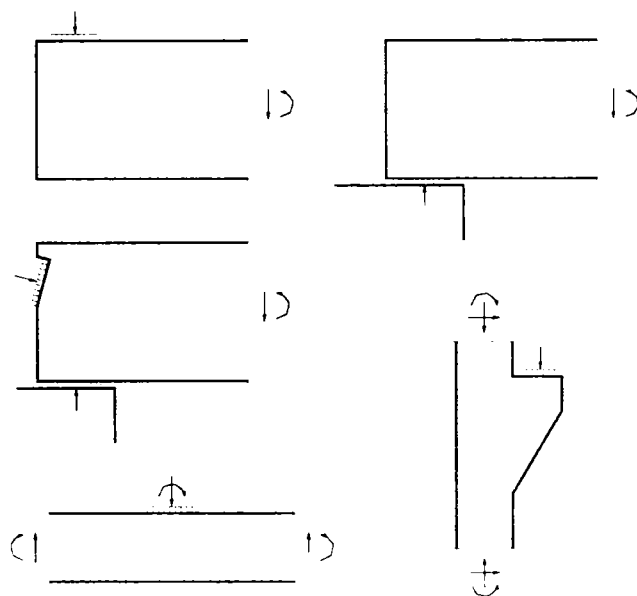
Zone de discontinuități statice în structurile și elementele din beton
